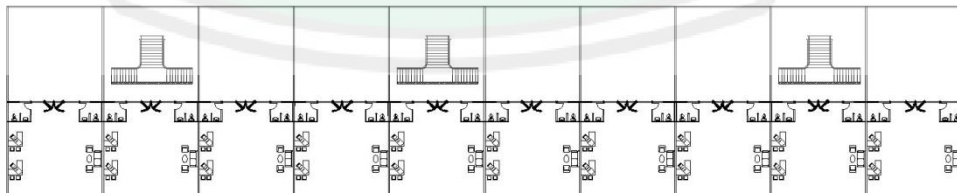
Denah lantai 1 Stadion Sepakbola Pantai
